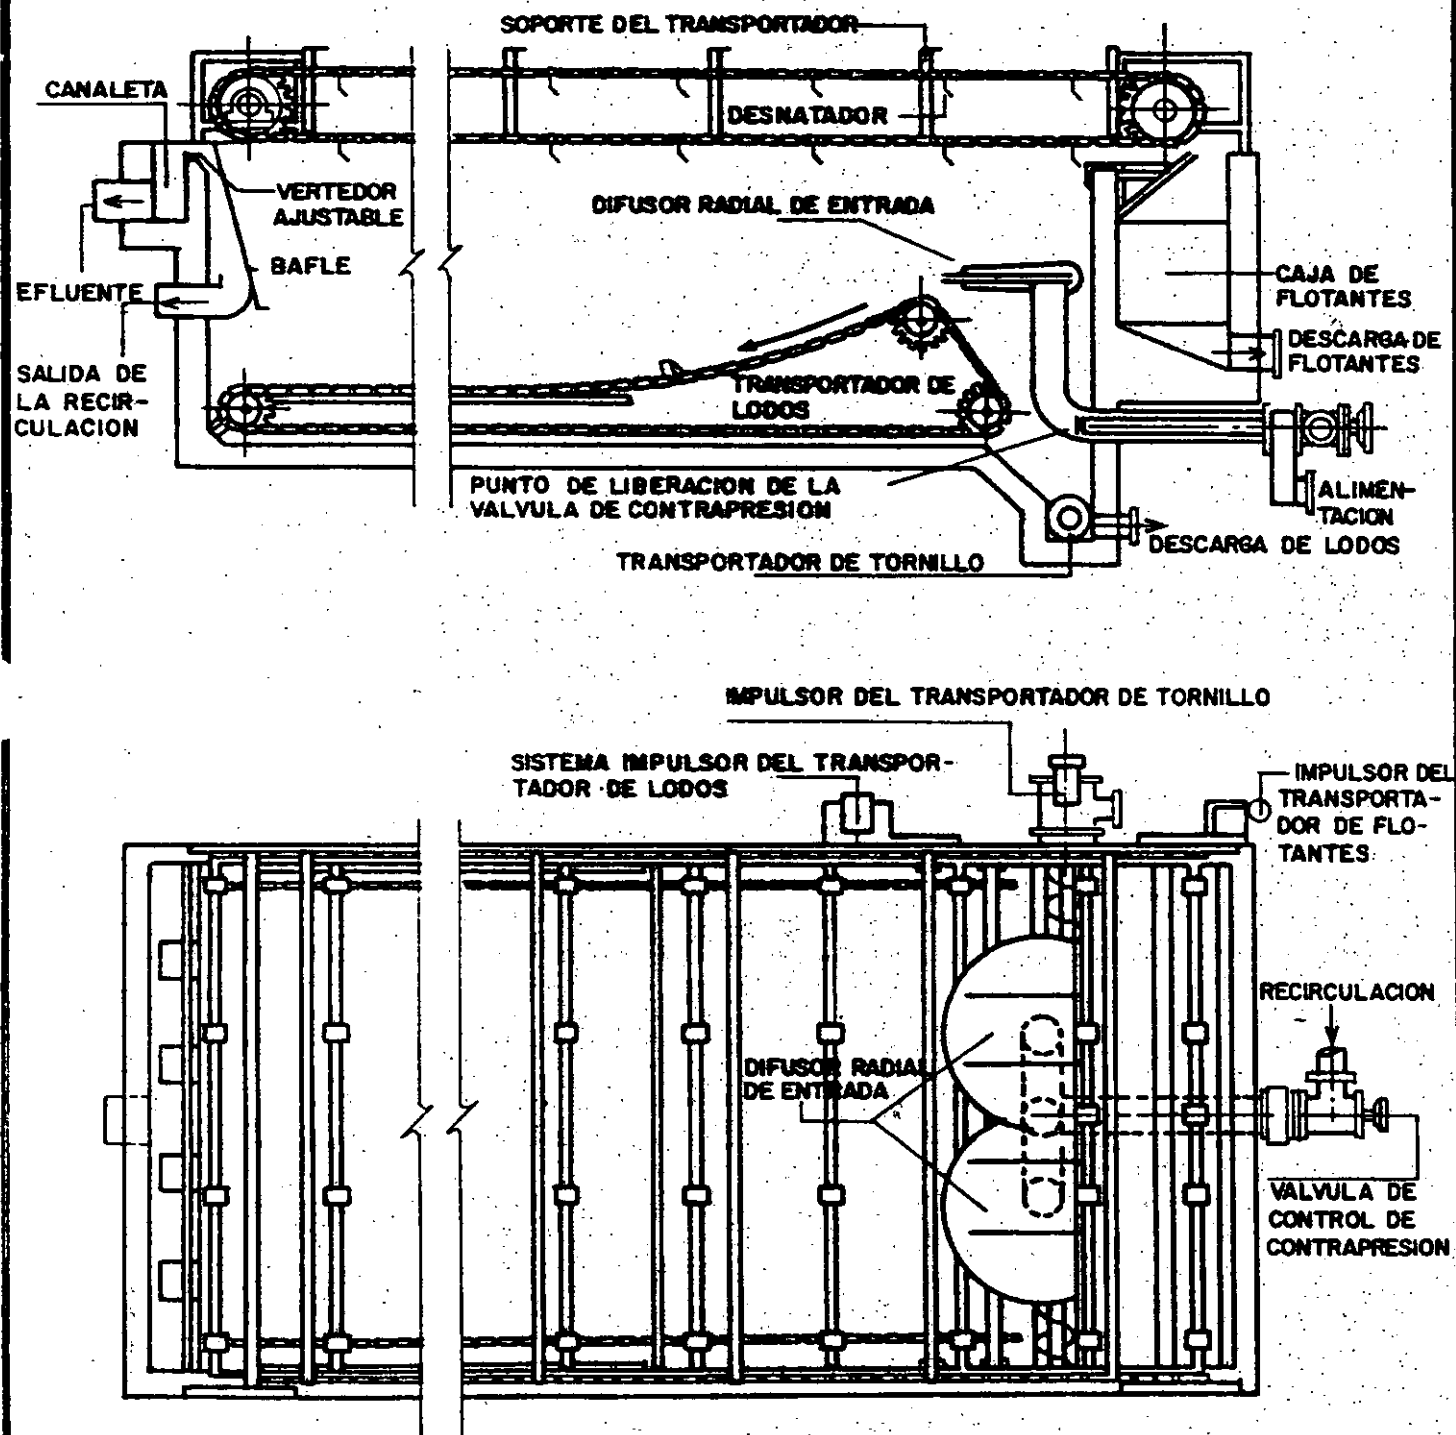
TANQUE DE FLOTACION - SECCION RECTANGULAR ESTRUCTURA DE CONCRETO REFORZADO
